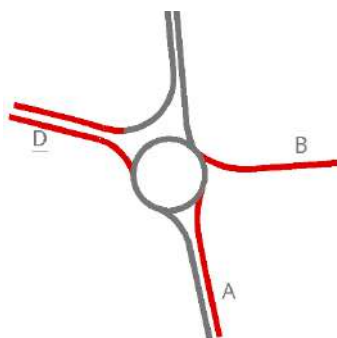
Schema intersezione via Fenzi – via Nazario Sauro – stato di progetto
